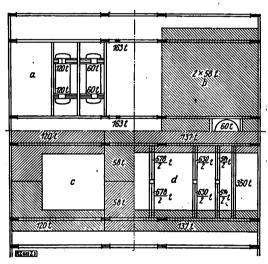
Teil des Kesselhaus-Grundrisses mit eingetragenen Lasten.
